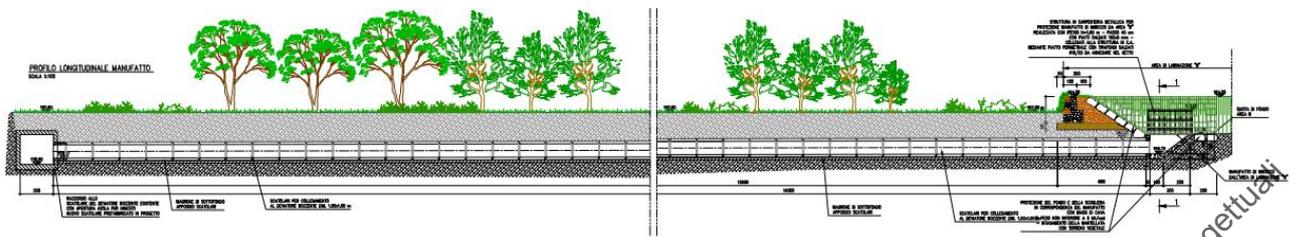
profilo longitudinale Scarico area di laminazione B. Estratto da Tav. 13.2
